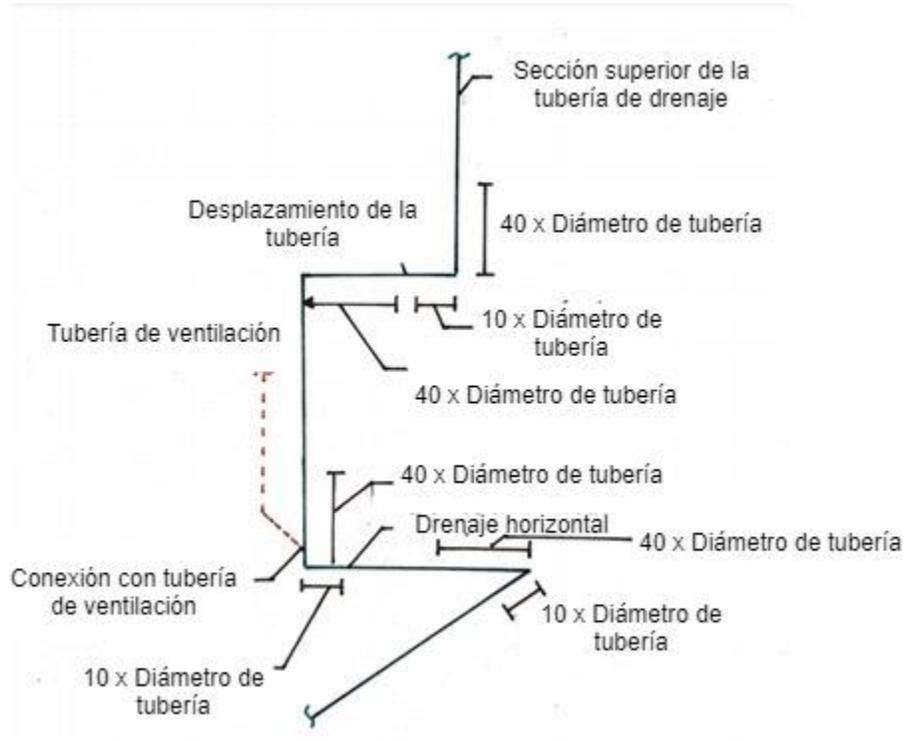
Zonas de presión de espumas en sección de tubería de drenaje
